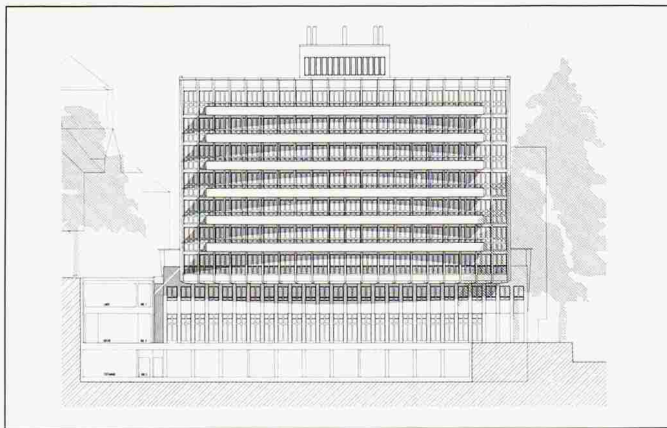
/15. Fassaden und Querschnitt für das Bauprojekt (Projekt Tertianum Adlerberg, St. Gallen)
